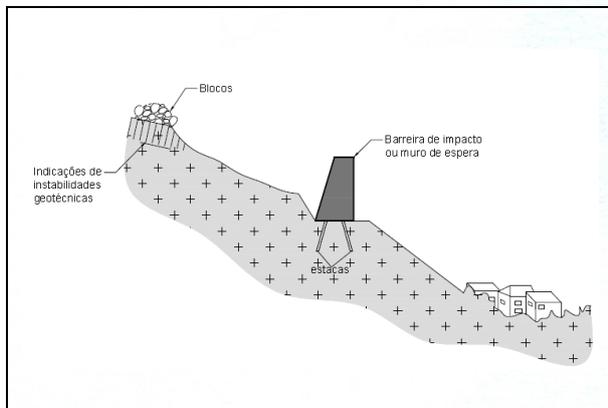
Contenção com muro de concreto ciclópico (adaptado de IPT, 1991).
